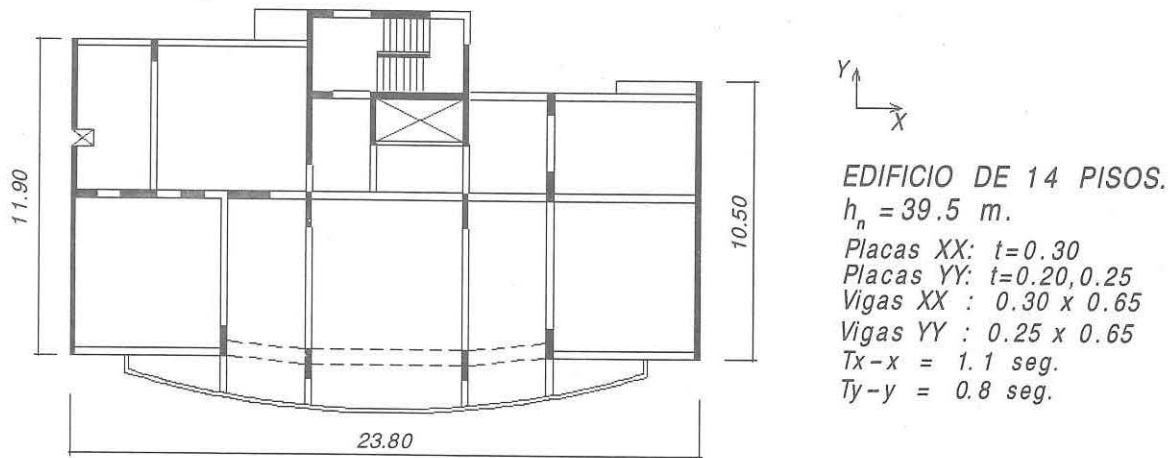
Edificio de 14 pisos estructurado con muros y pórticos de concreto armado.
